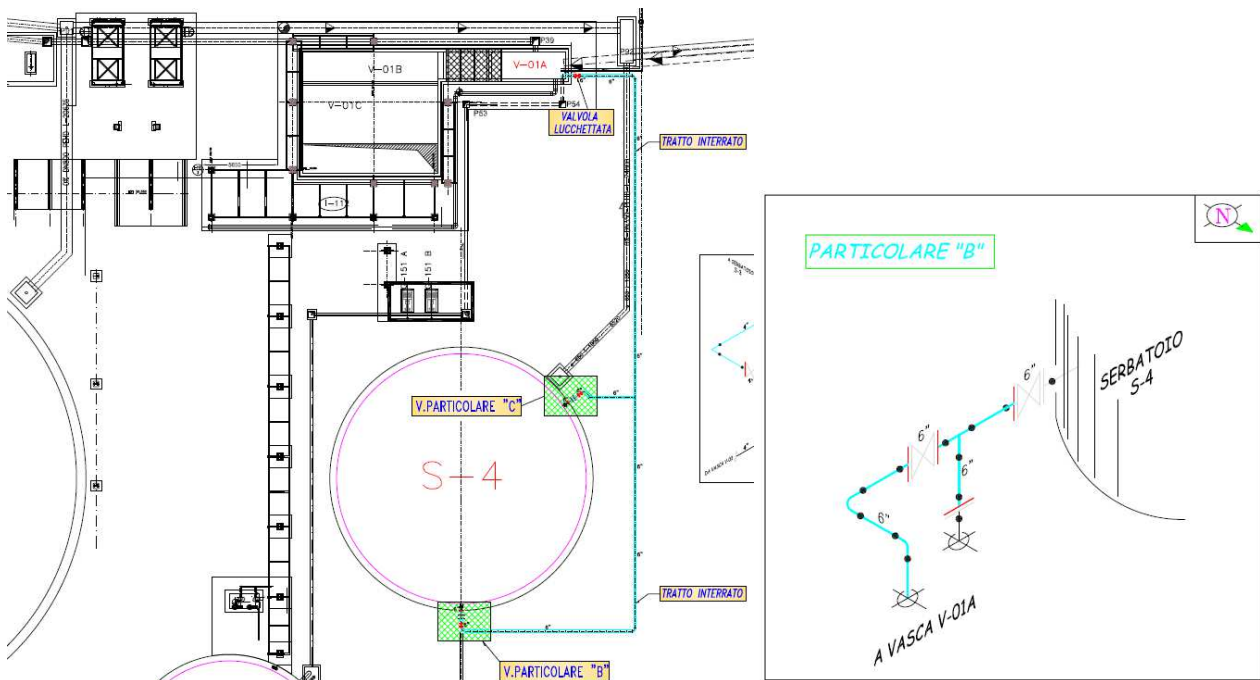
Stralcio planimetria sviluppo linea piping di collegamento (S-4 – V-01A)
